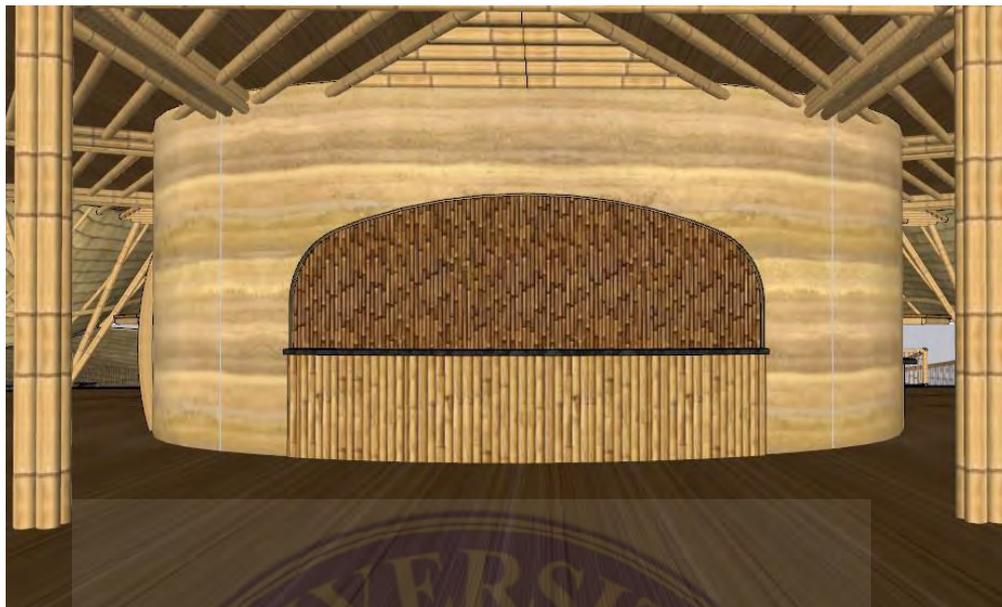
19 Sample cetakan Rammed Erath Wall
